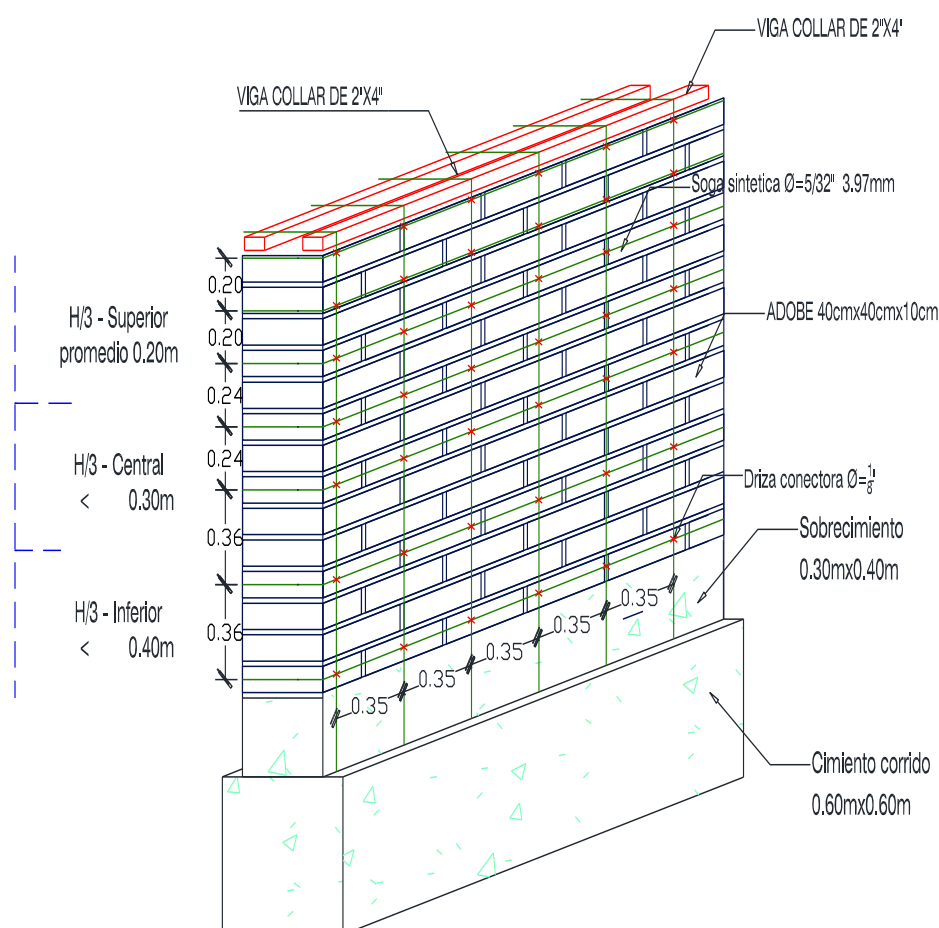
Refuerzo de muro de adobe con sogas sintéticas
